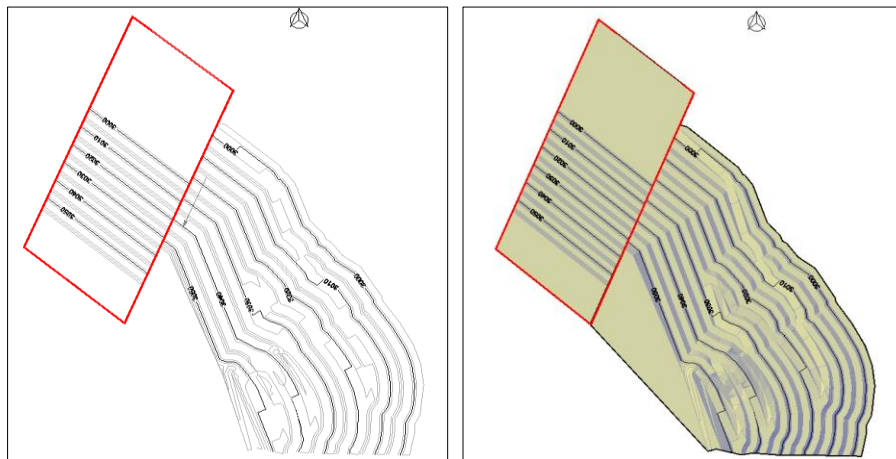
4: Vista en planta y 3D de la segunda etapa de explotación
